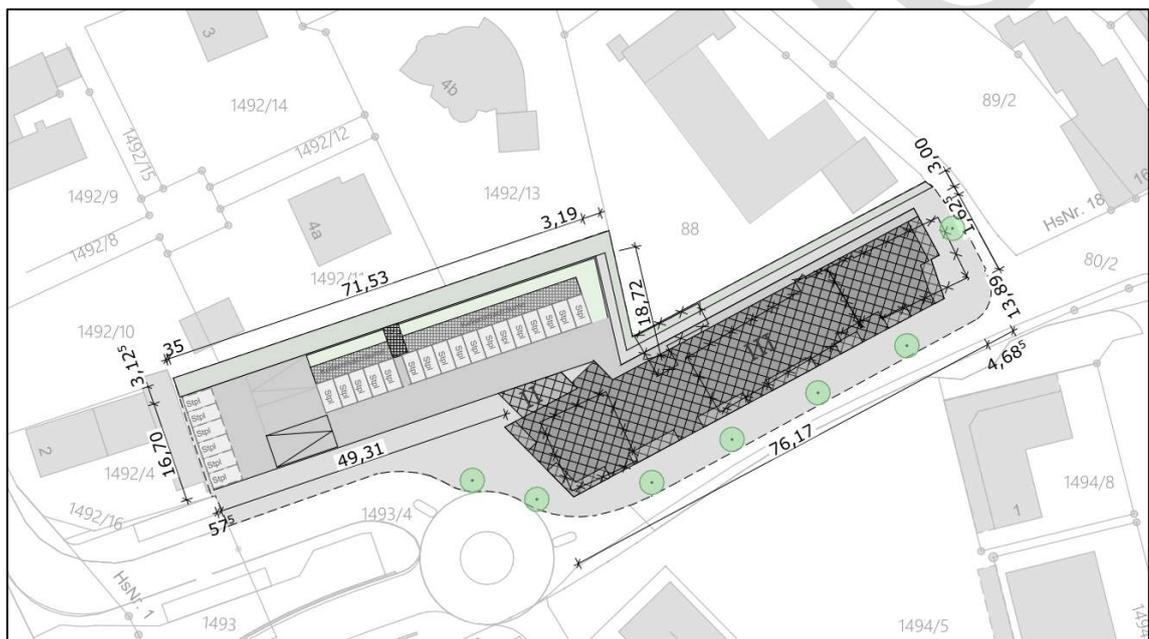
Ausschnitt VEP Lageplan (Plan Nr.: 01); BERZ.Architekten i. d. F. v. 28.01.2020, o. M.
